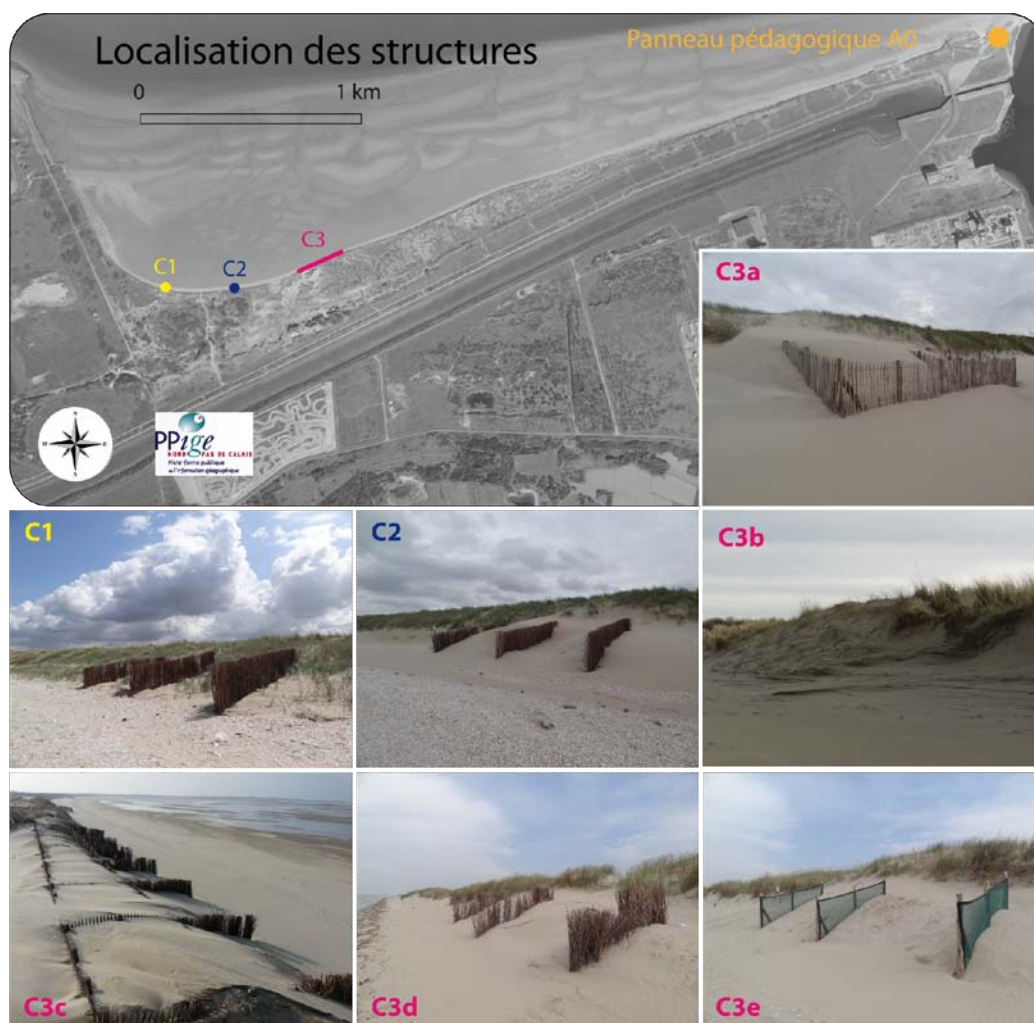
Localisation des structures de captage du sable sur la plage du Clipon
